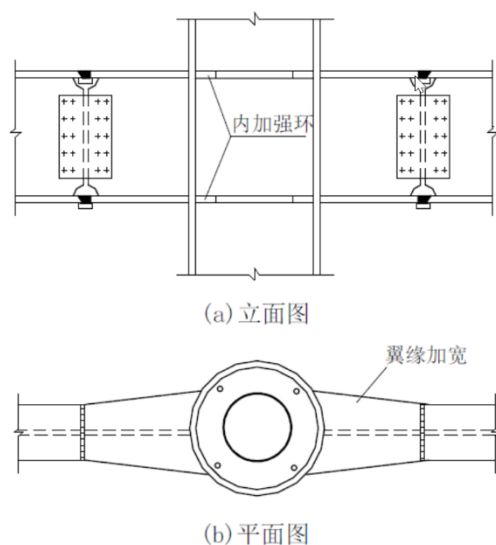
翼缘加宽的悬臂梁段与钢管混凝土柱刚性连接示意图
